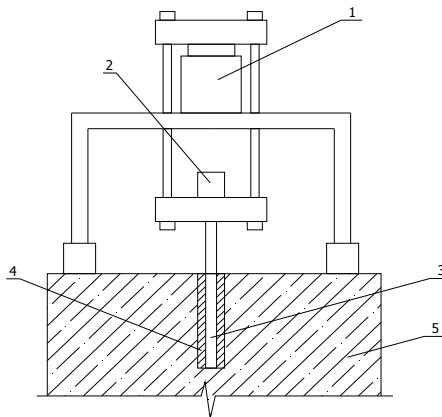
Установка для испытаний на выдергивание арматурных стержней из бетонного массива:
